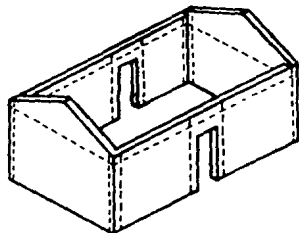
Refuerzo con tensores horizontales y verticales de acero.
